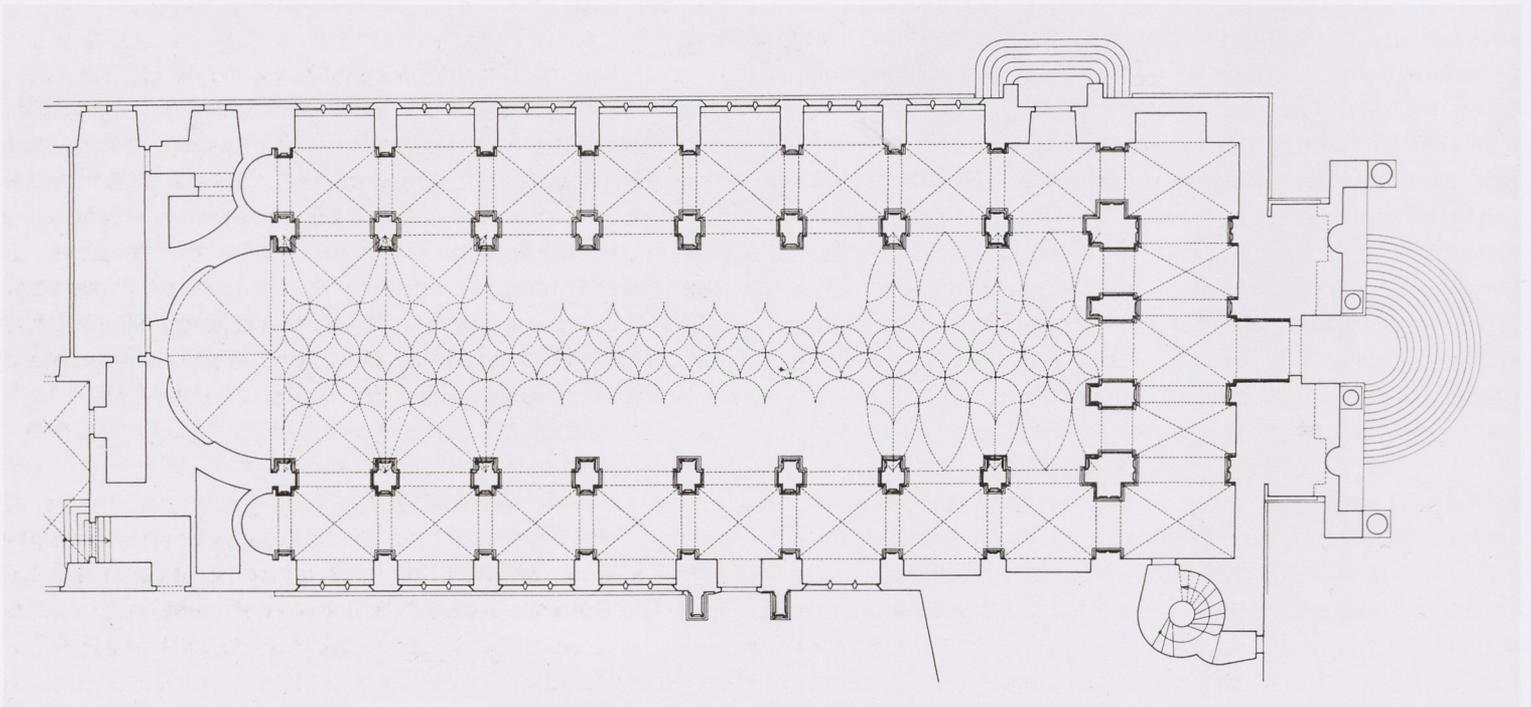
Grundriss der Würzburger Neubaukirche mit Gewölberekonstruktion
